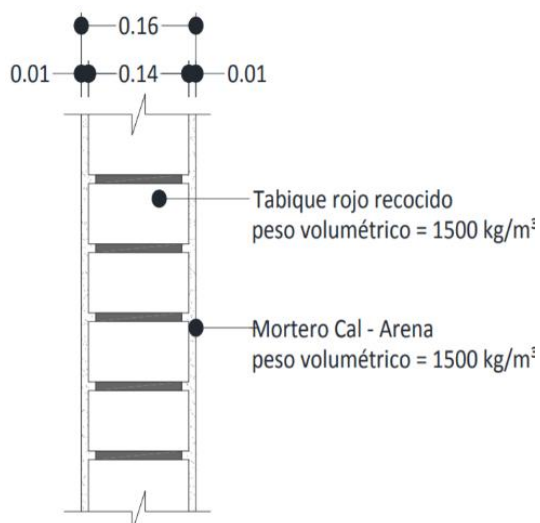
Detalle de muro divisorio de mampostería.
